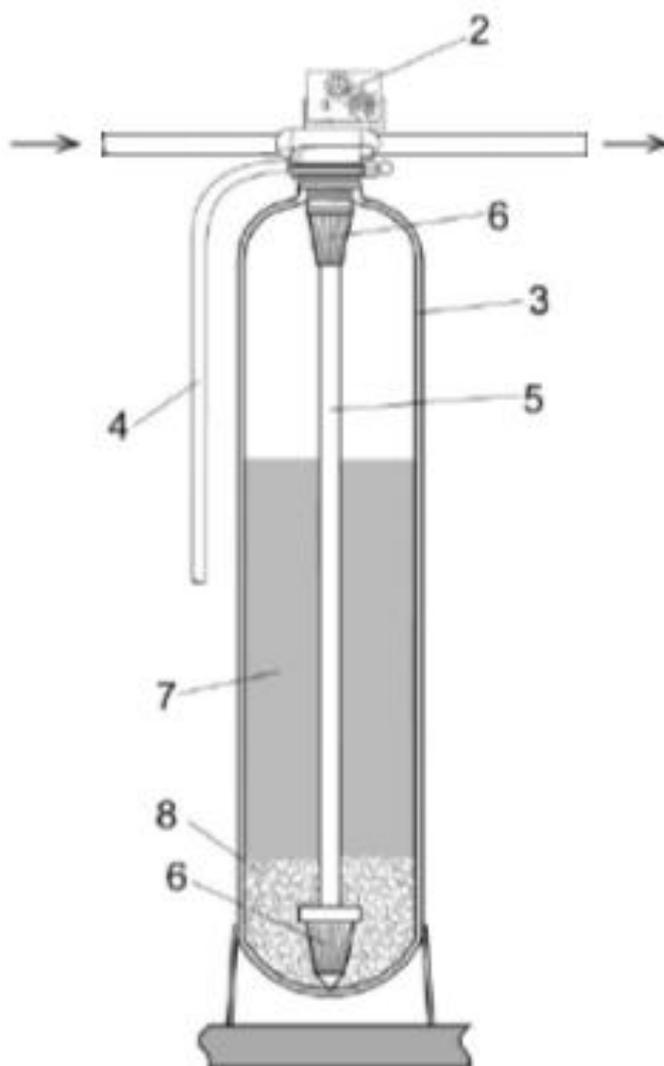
Устройство автоматического фильтра обезжелезивания: 1 – управляющий клапан; 2 – контроллер; 3 – корпус; 4 – дренажный шланг; 5 – распределительная труба; 6 – щелевая корзина; 7 – фильтрующая загрузка; 8 – поддерживающая засыпка.
